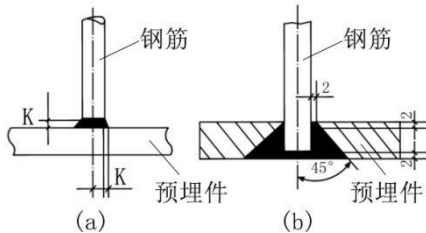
预埋件钢筋电弧焊 T 形接头
